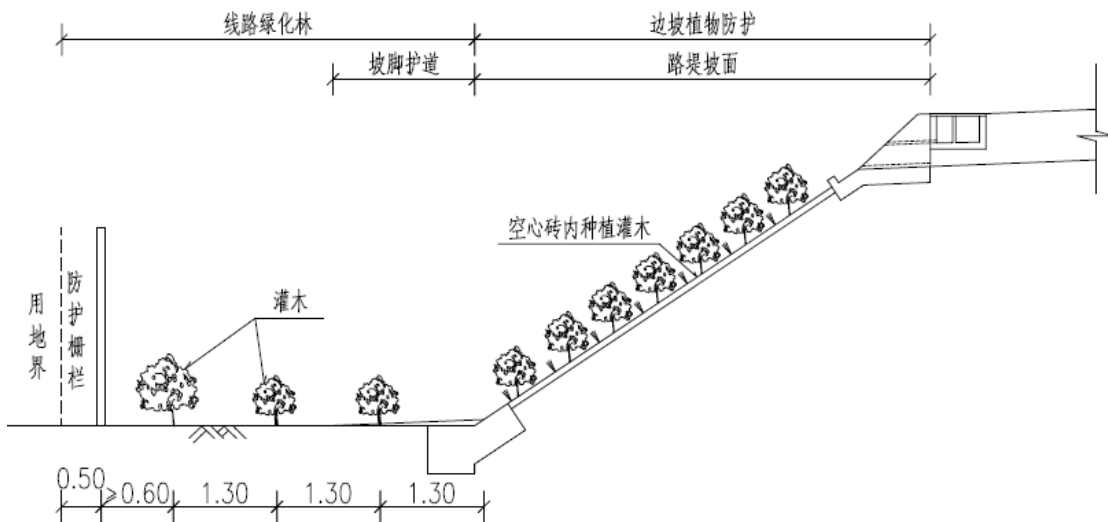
无排水沟路堤地段绿化断面示意图 (边坡高度<3m)
